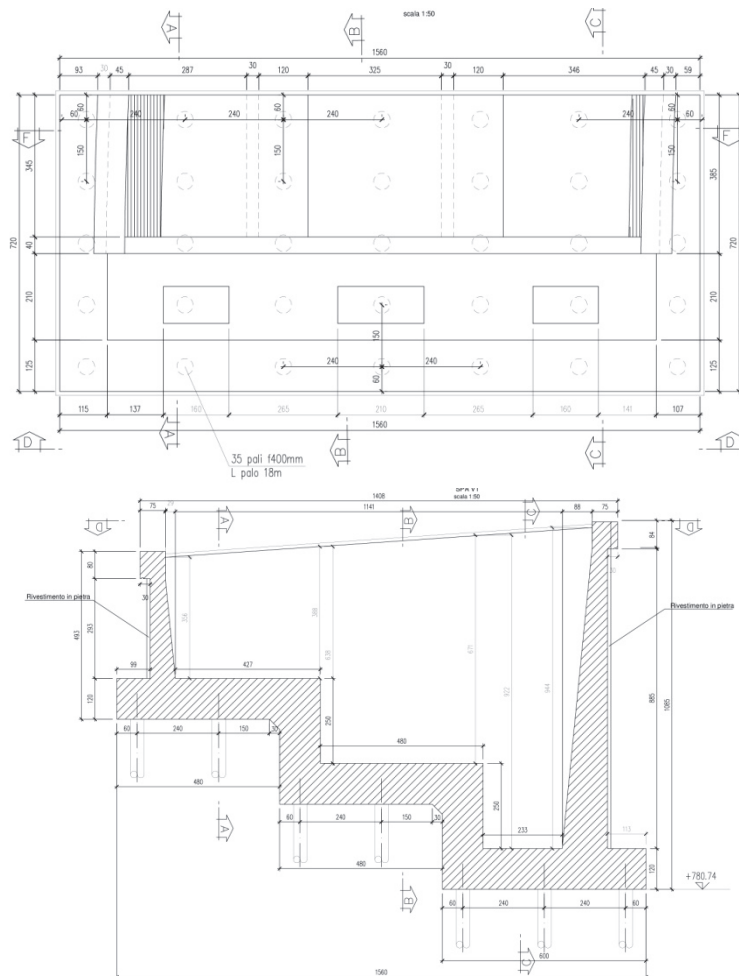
Spalla A: sezione trasversale e pianta
